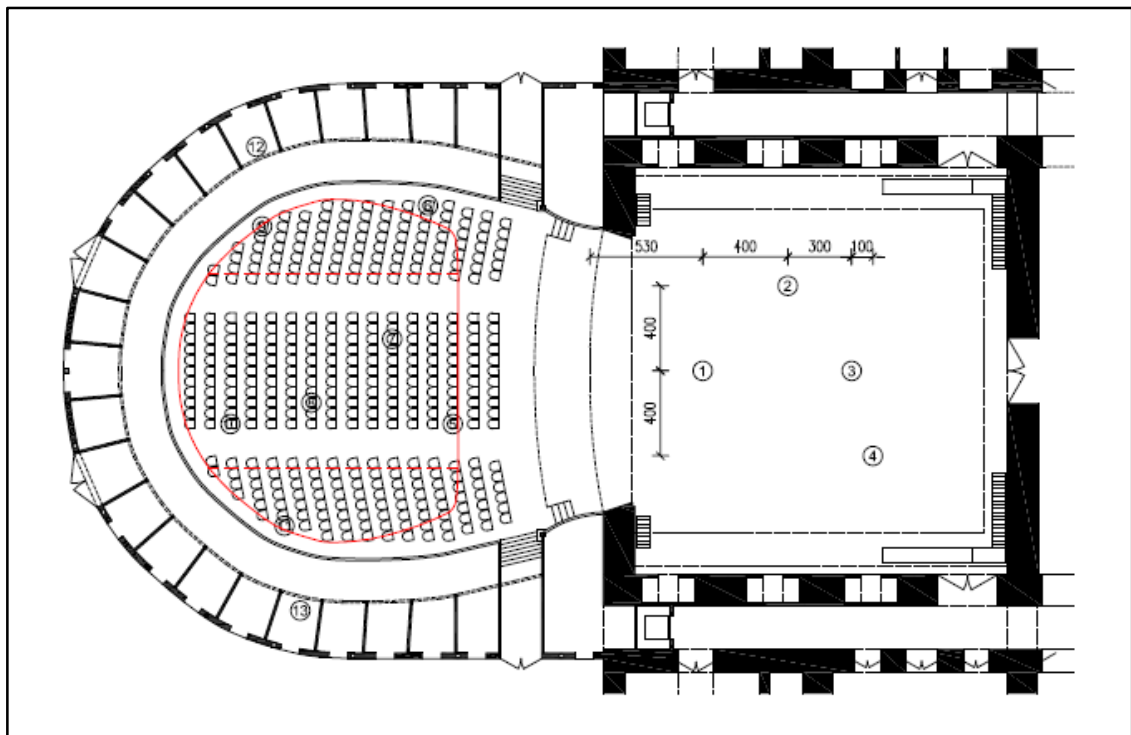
Posición de fuente y receptores en el proceso de medida, PLANTA BAJA
